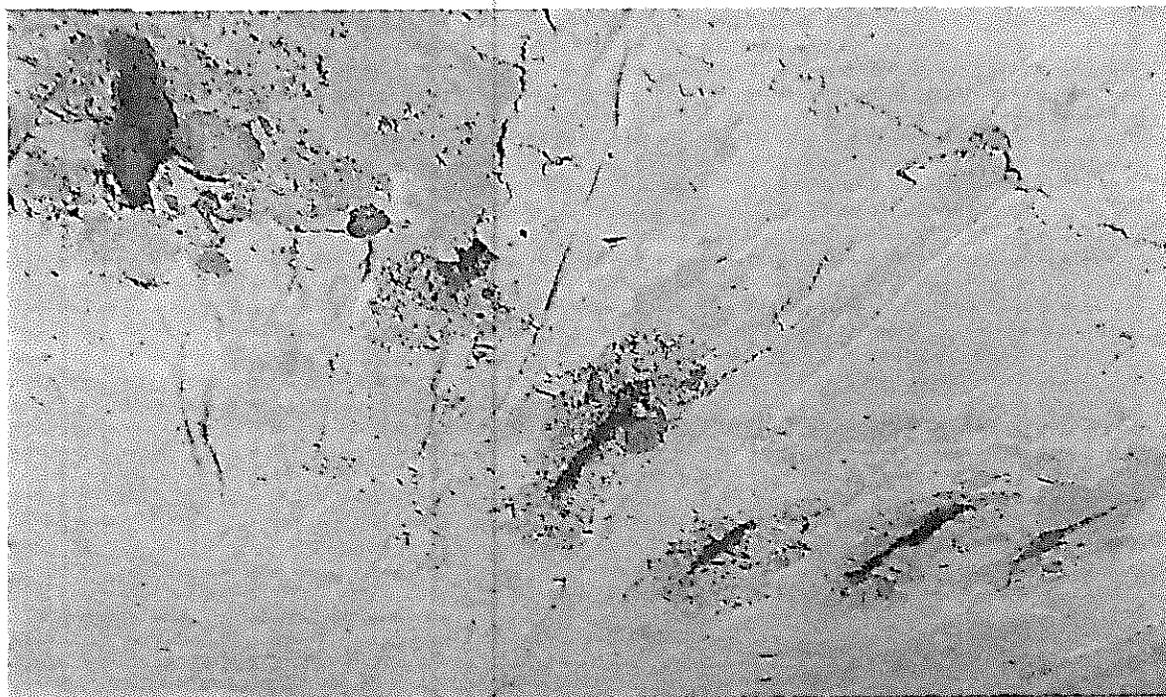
Exposición del acero de refuerzo en la losa de cubierta. "fuente propia".
